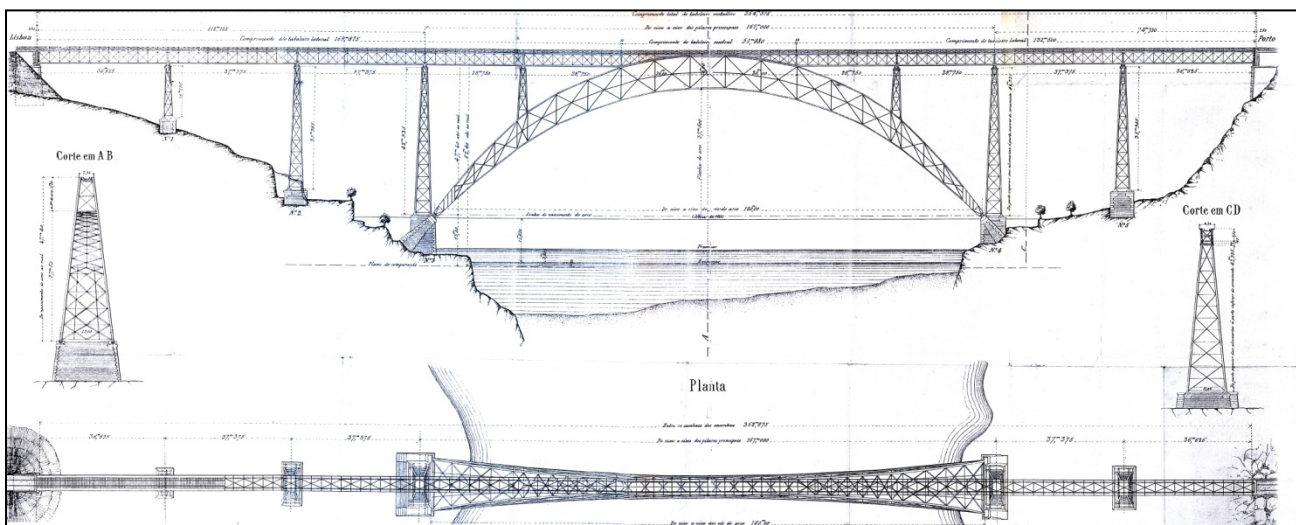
, Planos da Casa Eiffel para a Ponte Maria Pia: alçado Nascente e planta
